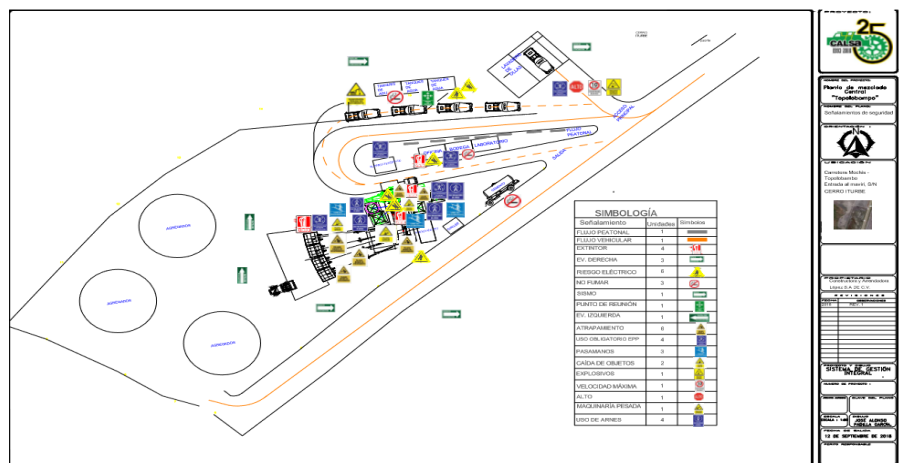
Plano de Planta con señalamientos. Fuente Propia.
